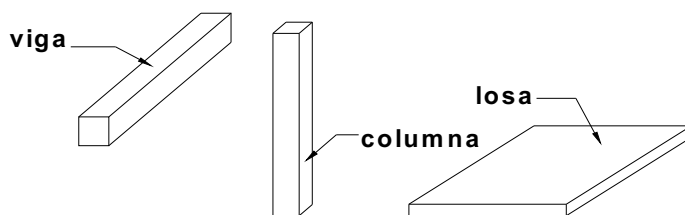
a Viga Fig. 1.32-b Columna Fig. 1.32-c Losa
